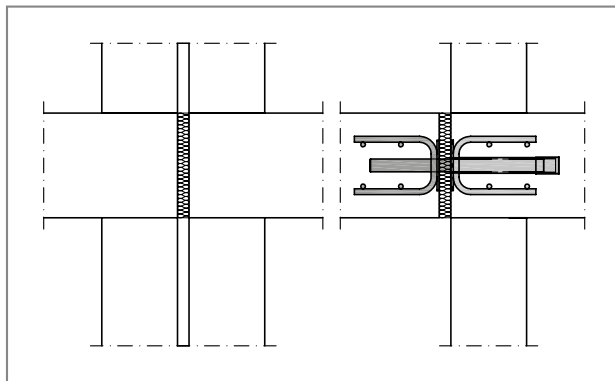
giunto di dilatazione con Schöck Dorn invece di un doppio pilastro o parete
